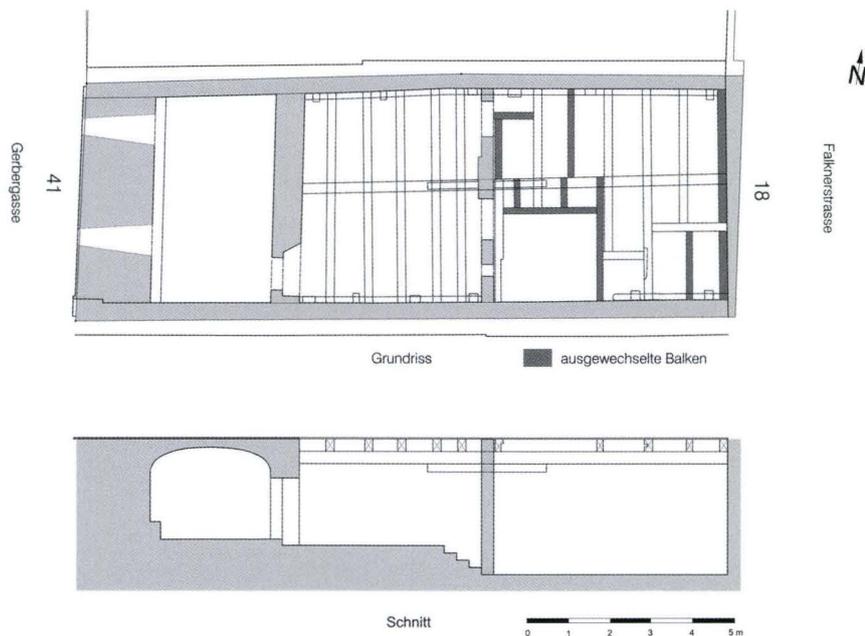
Gerbergasse 41. Untergeschoss. Grundriss und Querschnitt. Sekundäre Hölzer sind dunkel dargestellt. – Zeichnung: Hans Ritzmann.
